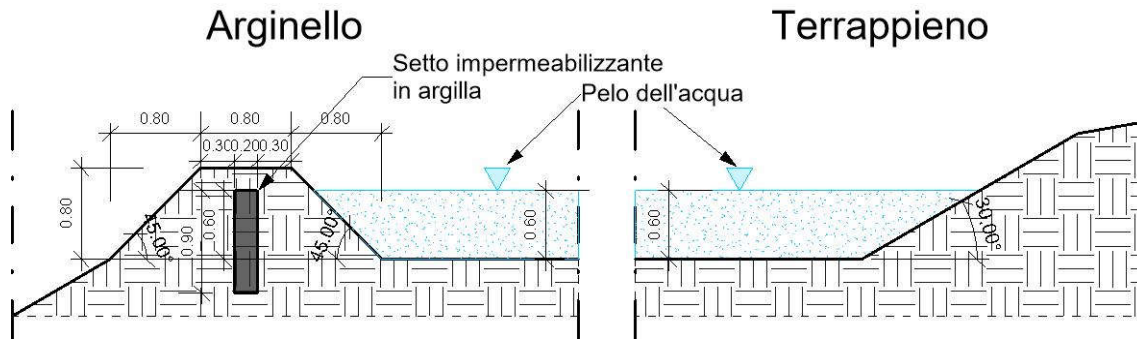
Dettaglio schematico delle strutture del bacino di laminazione e infiltrazione – Fuori scala
